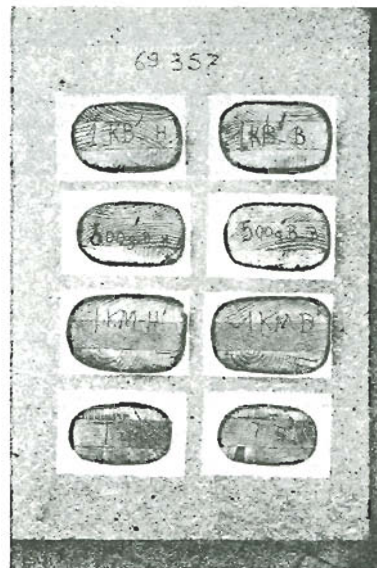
Segundo ensayo. Cortes: De arriba a abajo: Vigas 1 KB, 500 B, 1 KM. Testigo: A la izquierda corte H a 500 milímetros, A la derecha corte B a 250 milímetros
